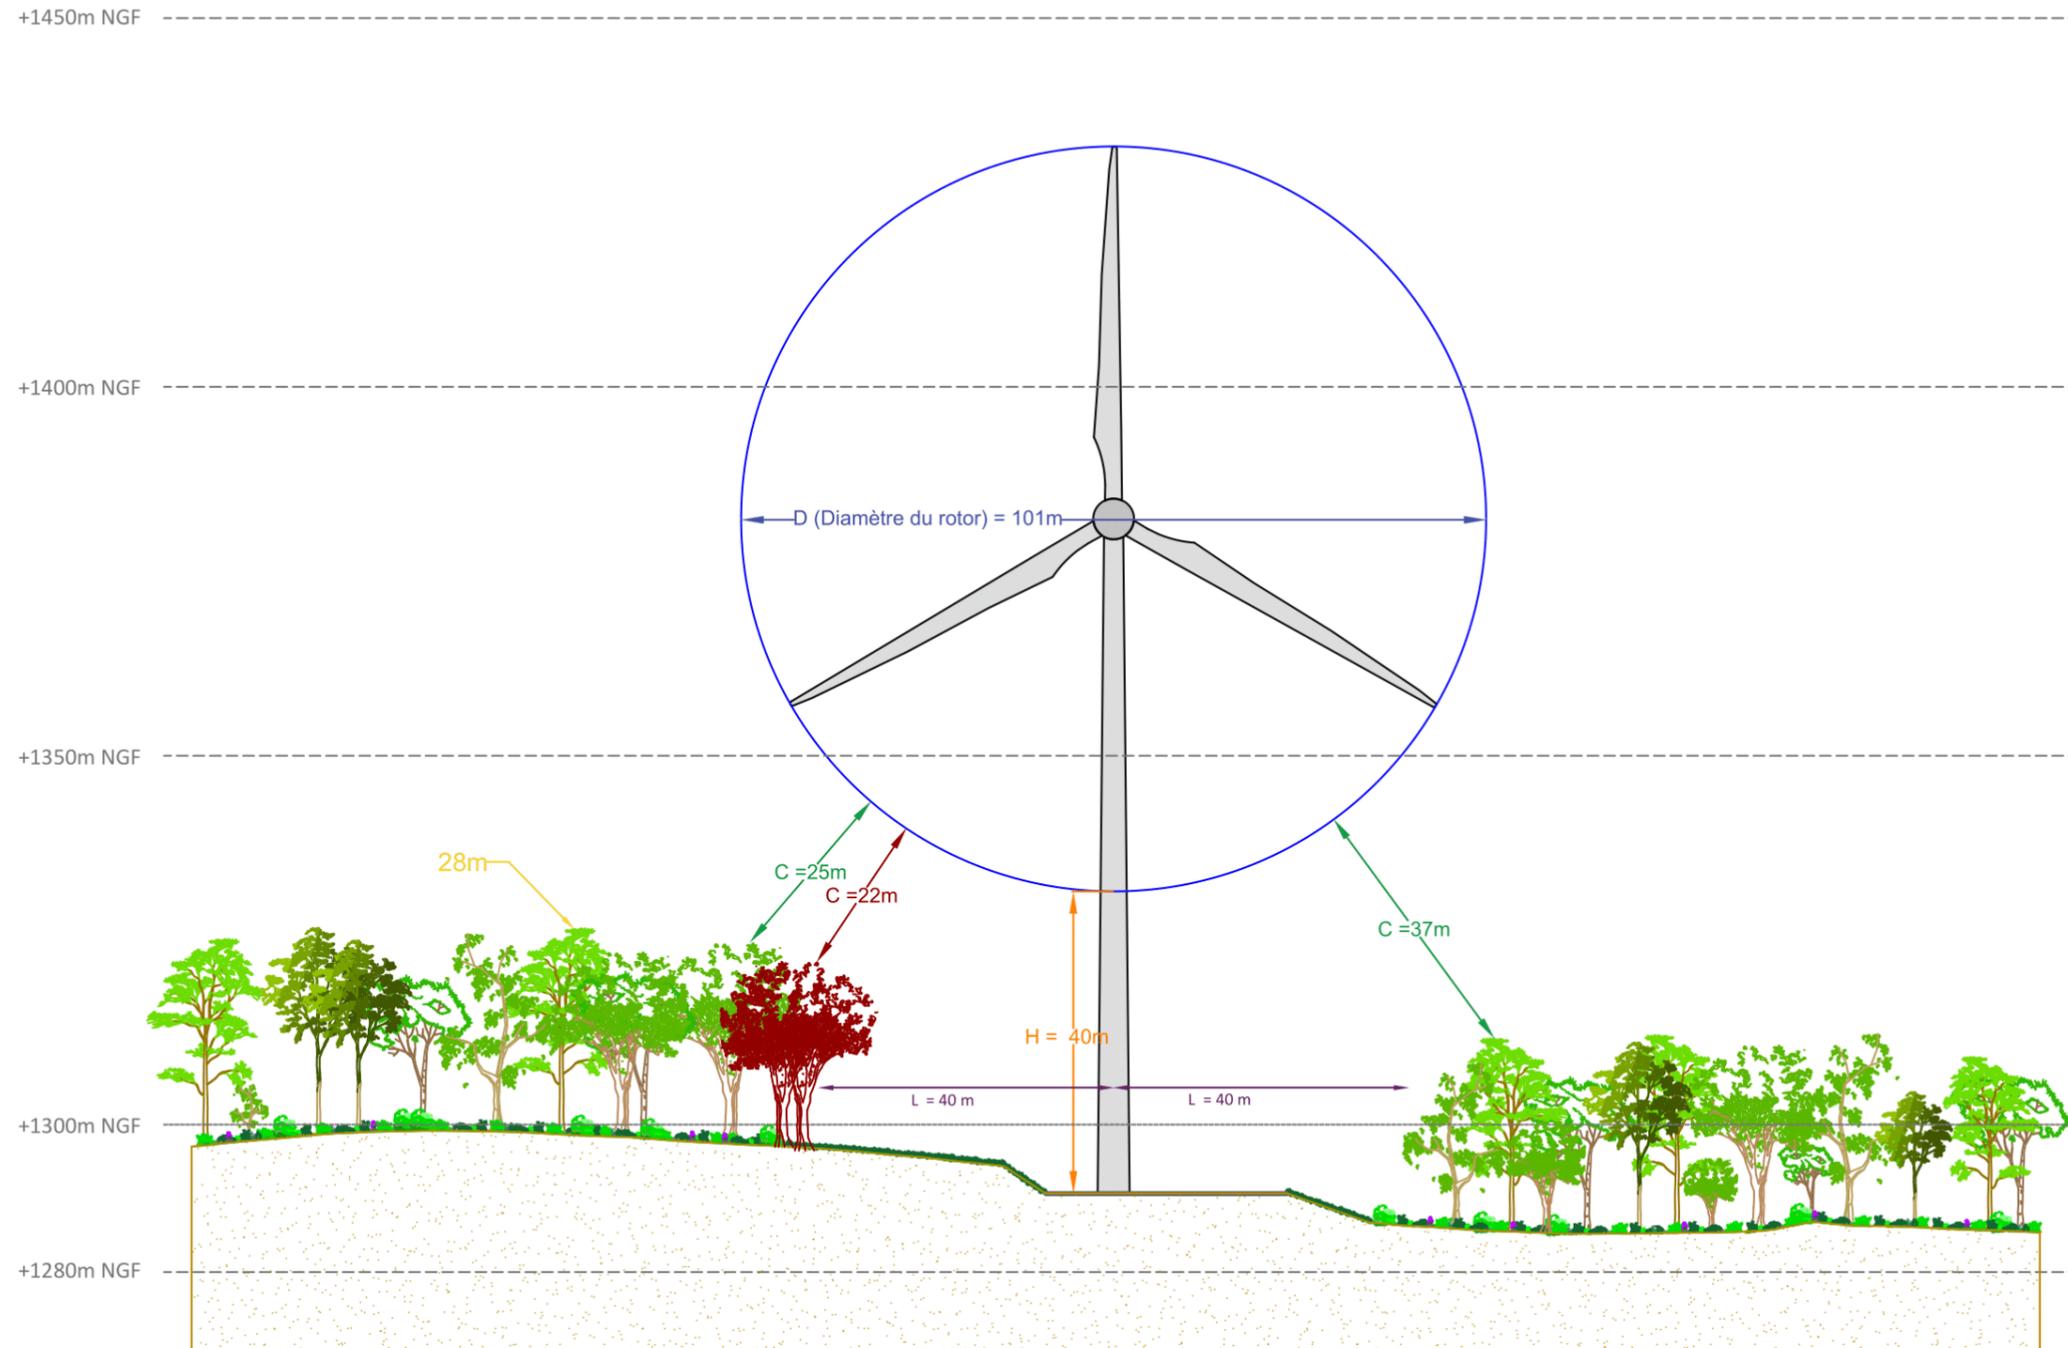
Plan de coupe et distance aux lisières (éolienne E2)
